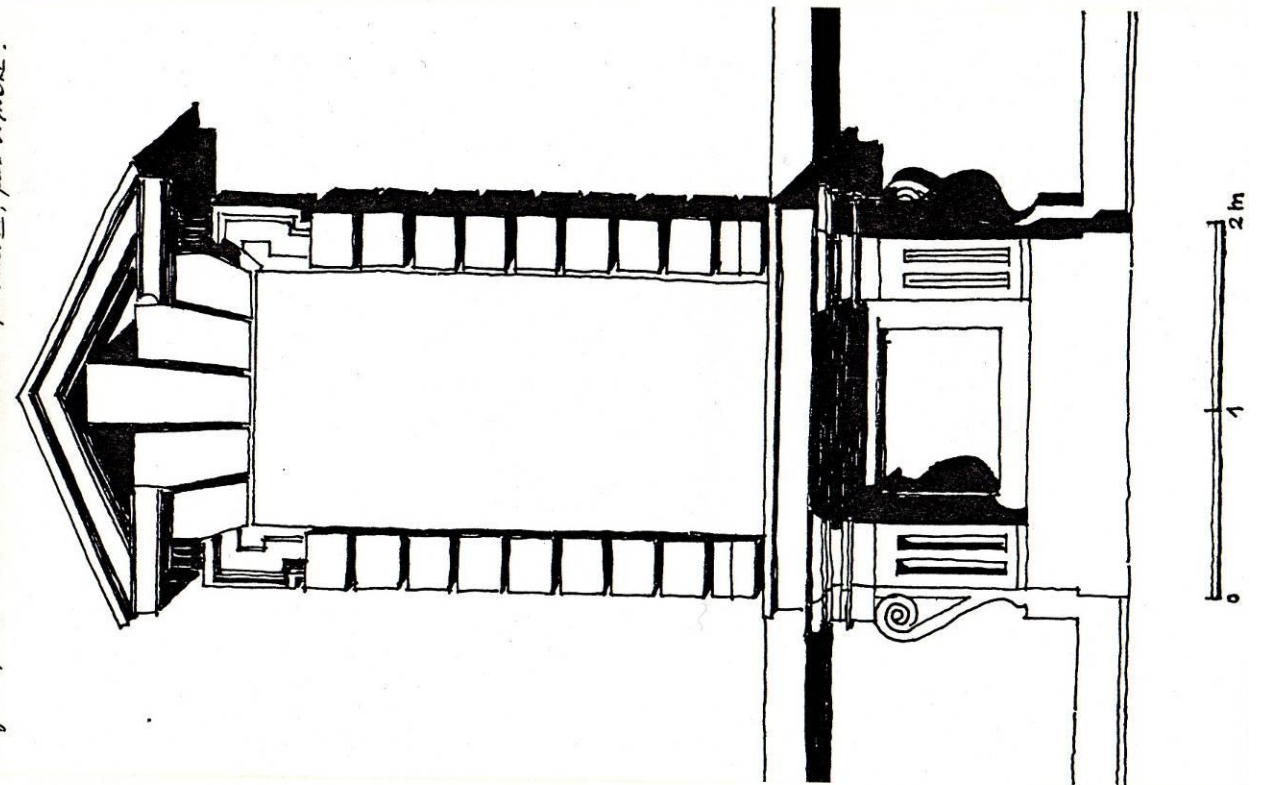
/344: PLAN, COUPE, ÉLEVATION ET DÉTAILS D'UNE FENÊTRE A BOSSAGES - GROUROT (21)
